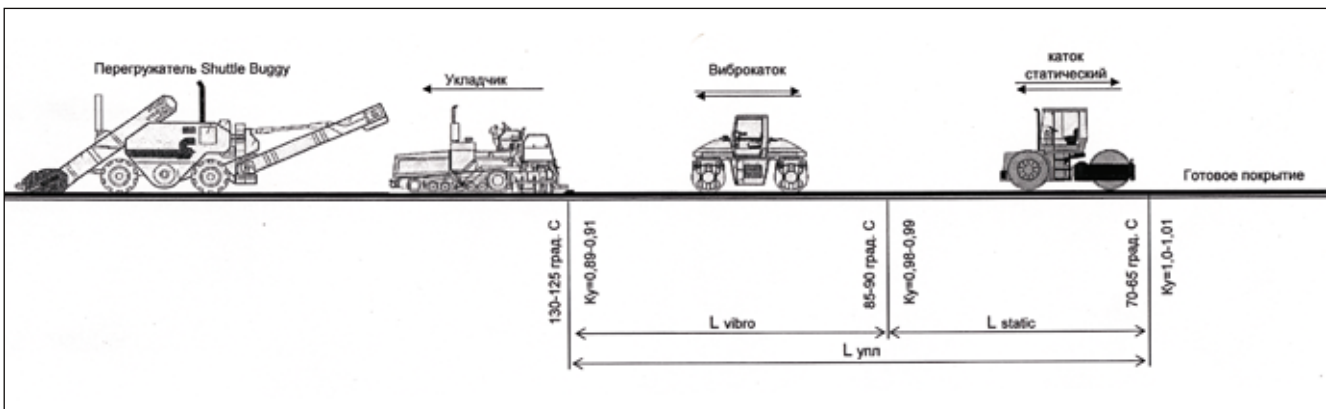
Технологическая схема укладки и уплотнения асфальтобетонного покрытия на объекте ЗАО «ВАД»
